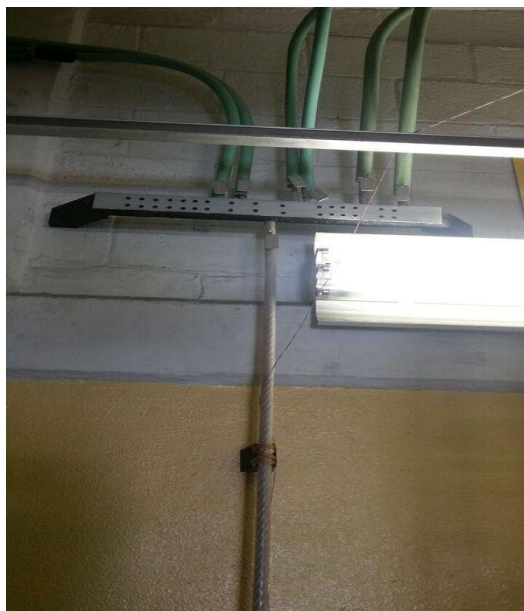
Conductor de puesta a tierra de equipos y carcasa conectados a un bus dentro de la central telefónica.
